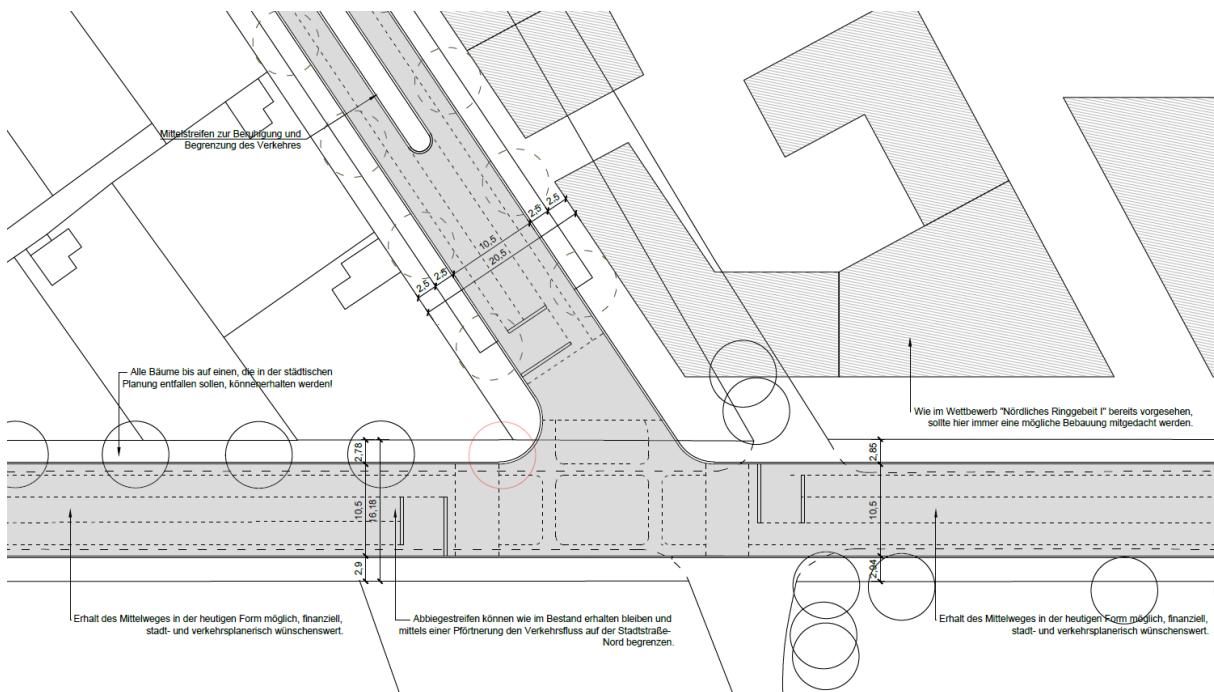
Alternativentwurf für einen ersten, östlichen Bauabschnitt der Stadtstraße-Nord. Der Mittelweg bleibt unverändert bestehen, die Stadtstraße wird in Anlehnung des Mittelweges gestaltet.
